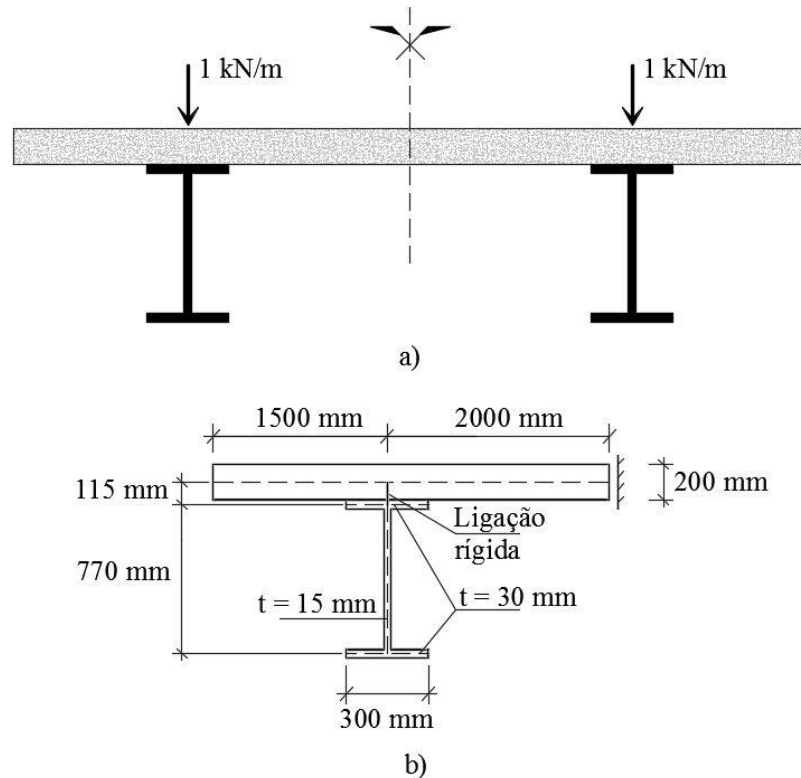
Geometria da seção transversal das vigas utilizadas em Henriques, 2014. (a) Seção transversal da viga completa. (b) Seção transversal de simetria.
